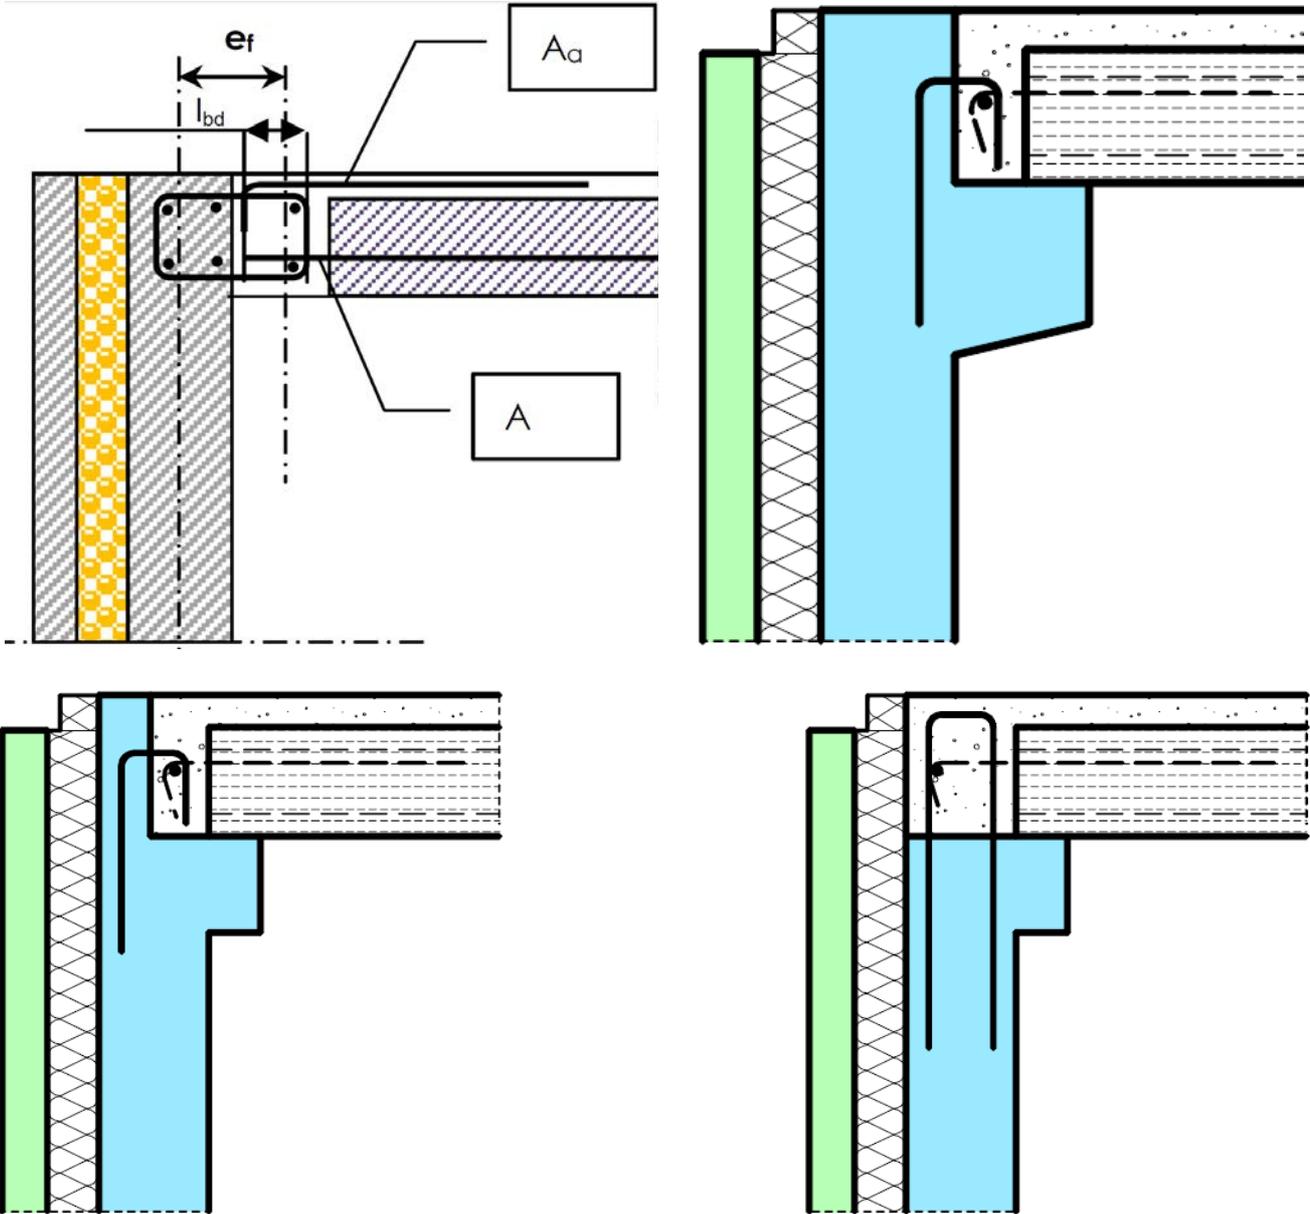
liaison avec plancher en béton à dalles alvéolaires
